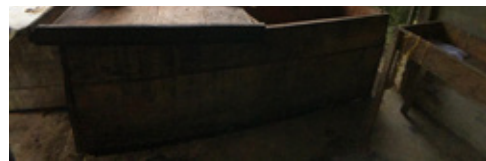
Detalle interno de sistema constructivo de cajones de madera.
